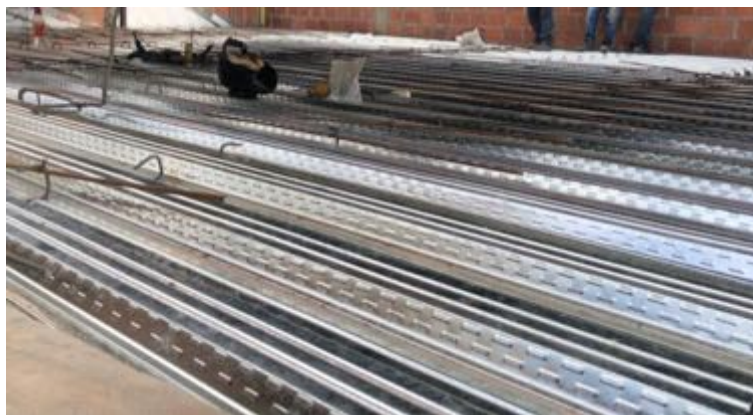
Lamina de Metaldeck (Fuente propia).
